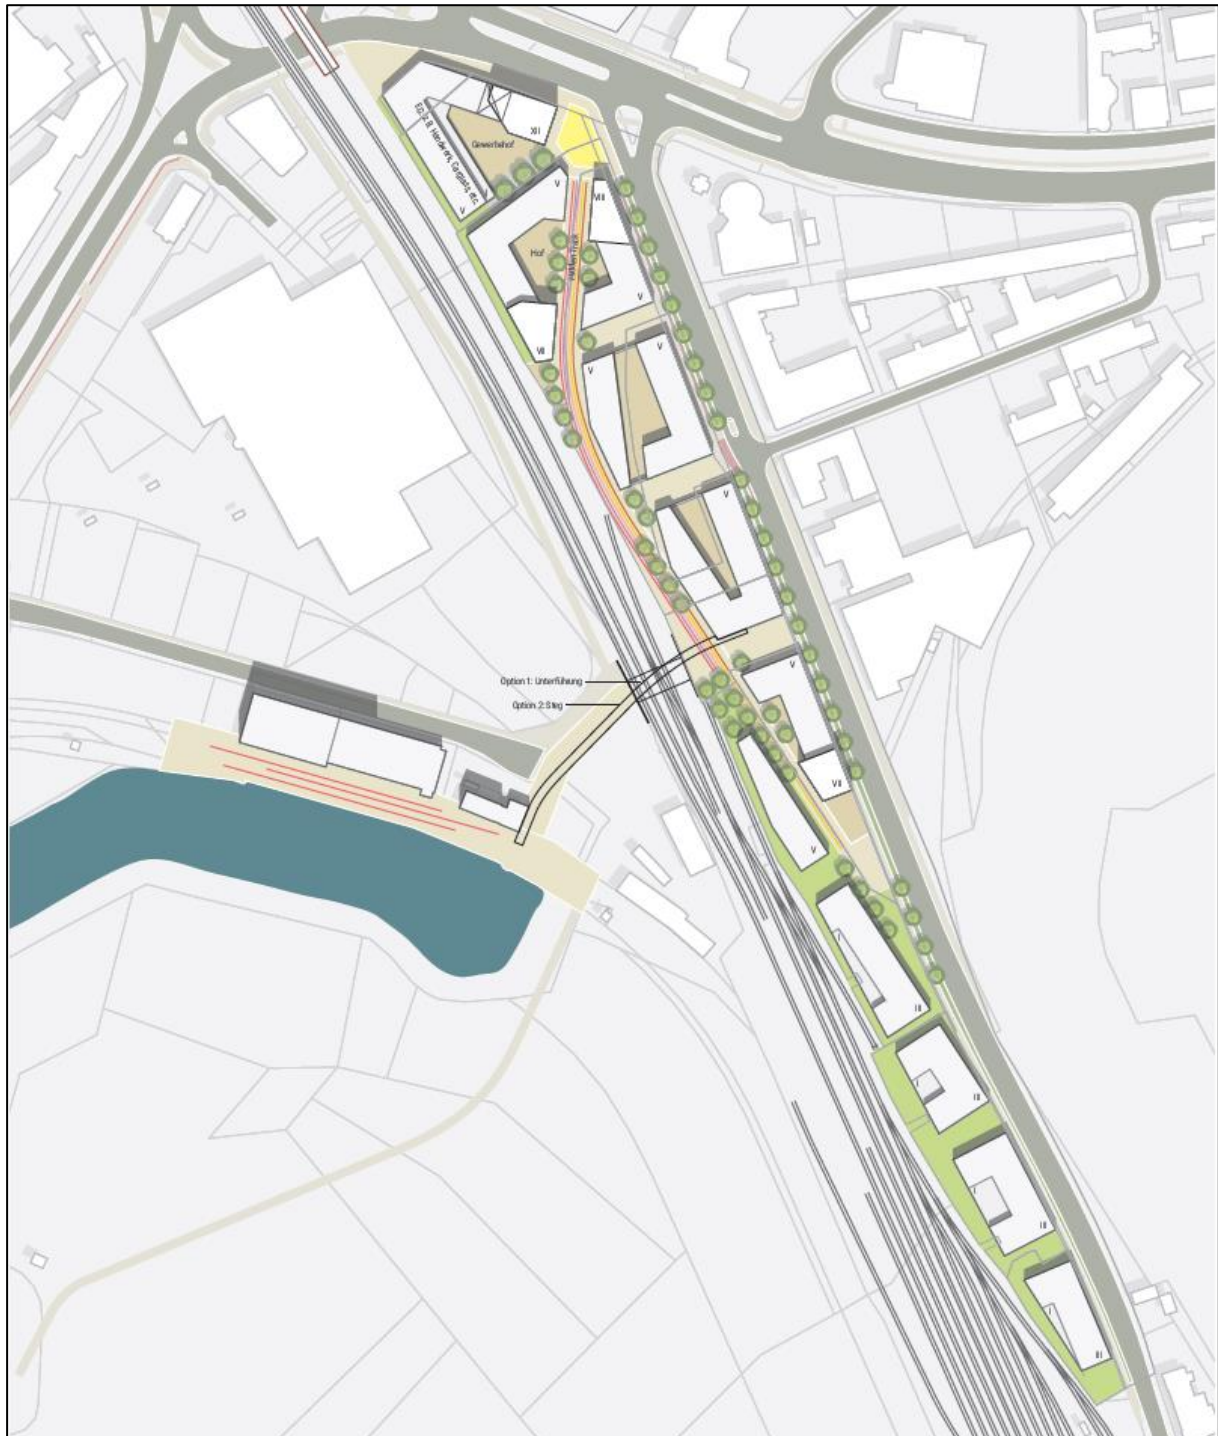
Städtebaulicher Entwurf Band westlich der Brebacherlandstraße, Vorzugsvariante (Datum/Stand: 24.01.2023 / Vorabzug, Städtebau Brebacher Landstraße, Saarbrücken; i.A.: Landeshauptstadt Saarbrücken, Stadtplanungsamt; Planverfasser: MESS Stadtplaner Amann & Groß PartGmbH) am 28.März 2023 vom Stadtrat beschlossen und dient als Grundlage für das weitere Bebauungsplanverfahren.
